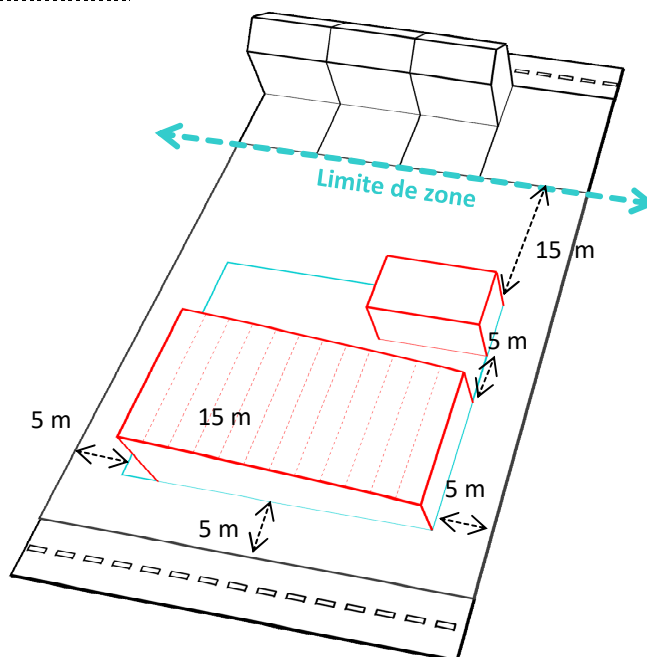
Implantation des constructions dans le secteur UAE3-U
